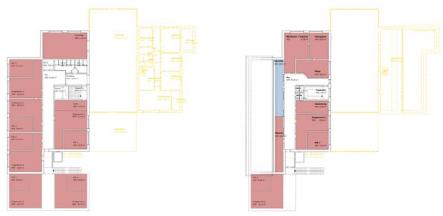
Grundrisse zum Hortumbau, Mitte
